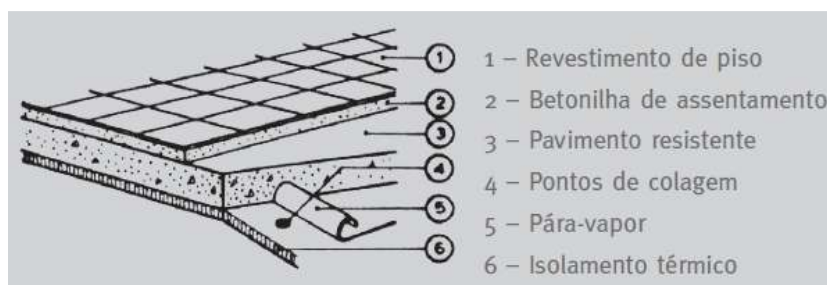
Pavimentos sobre espaço exterior ou não-aquecido – Isolamento térmico inferior [6]
